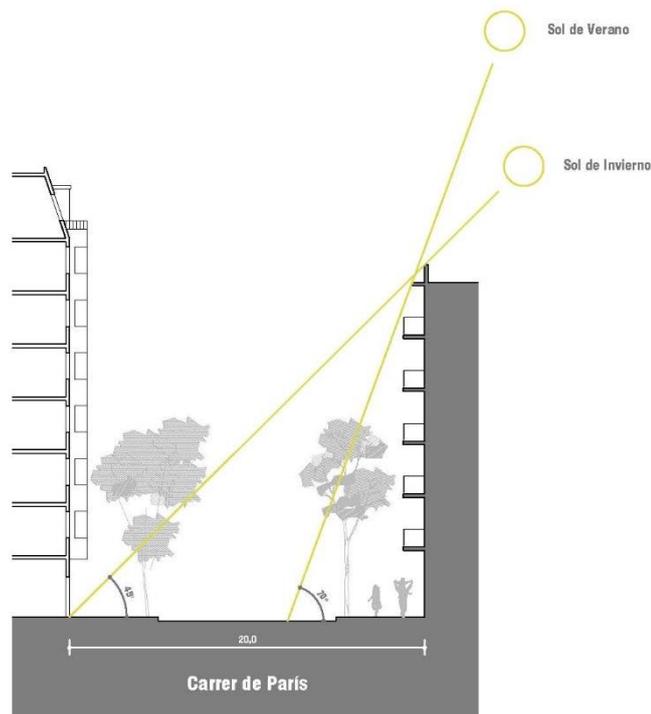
Sección tipo del carrer París. Los 20m de distancia entre las fachadas a ambos lados de la calle permite un correcto asoleamiento de la fachada. Fuente elaboración propia.
